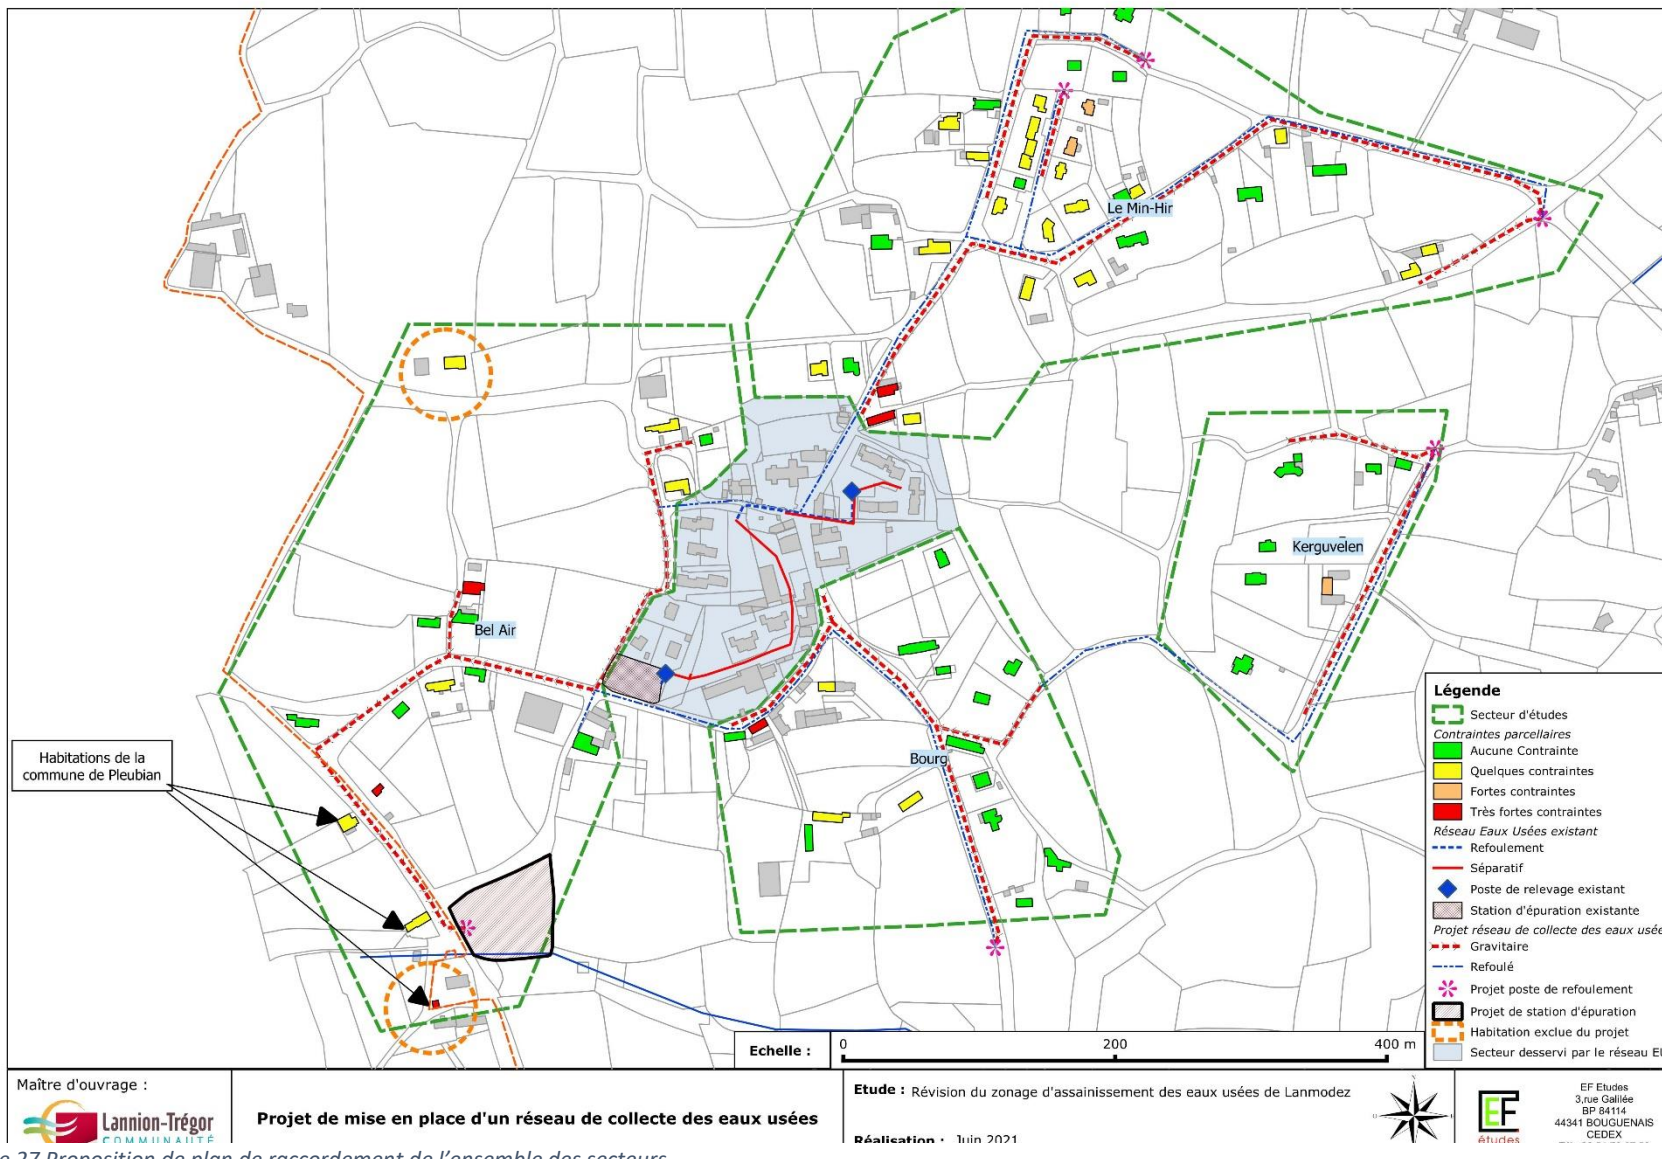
Proposition de plan de raccordement de l'ensemble des secteurs
